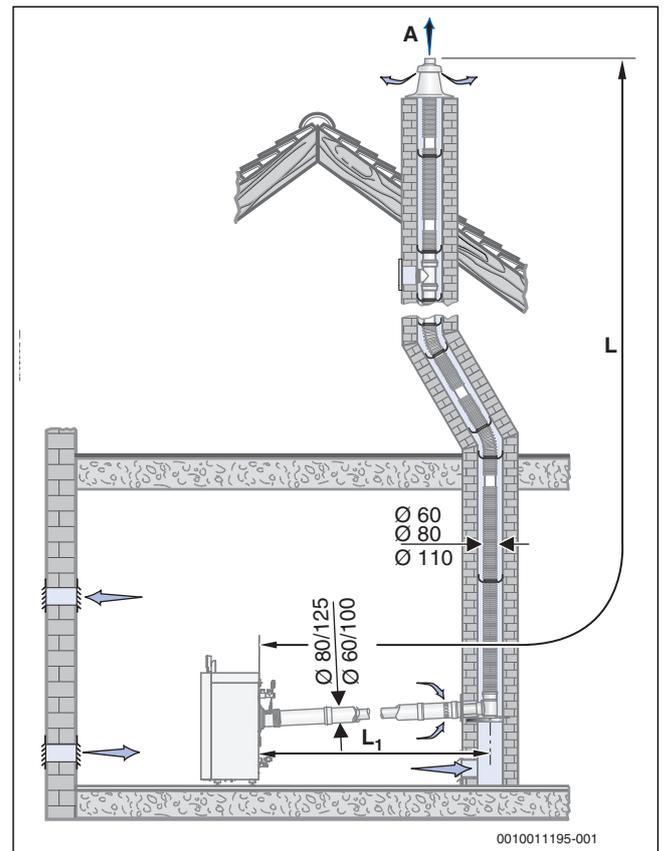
Montagevariante mit dem Bausatz GA-X + GA-K + ÜB-Flex
